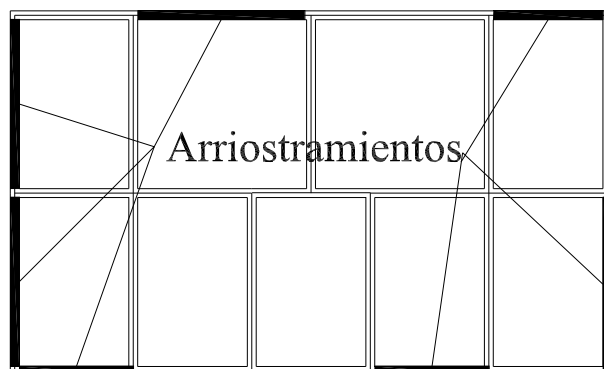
Disposición de arriostramientos disipativos en planta para una estructura de edificación
